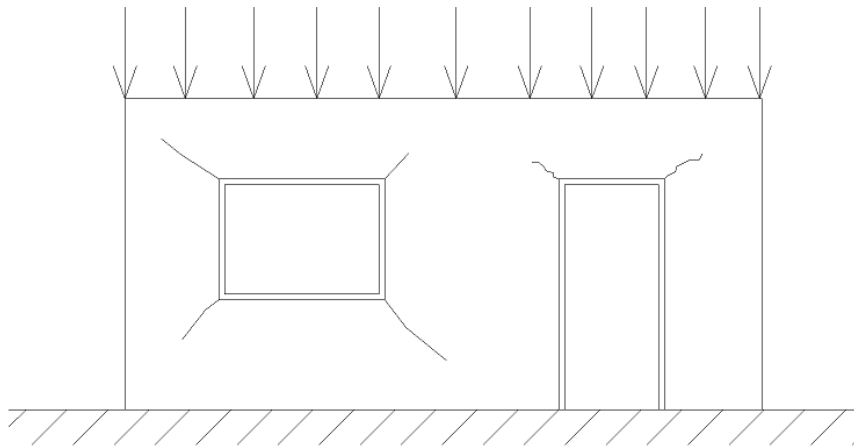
Fissuras ocasionadas por concentração de tensão nos cantos de aberturas em alvenarias- Adaptada de THOMAZ (2007)
